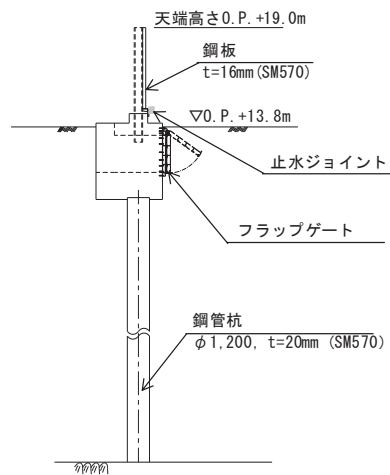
10. 4-7 鋼製遮水壁 (鋼板) 正面図及び断面図
